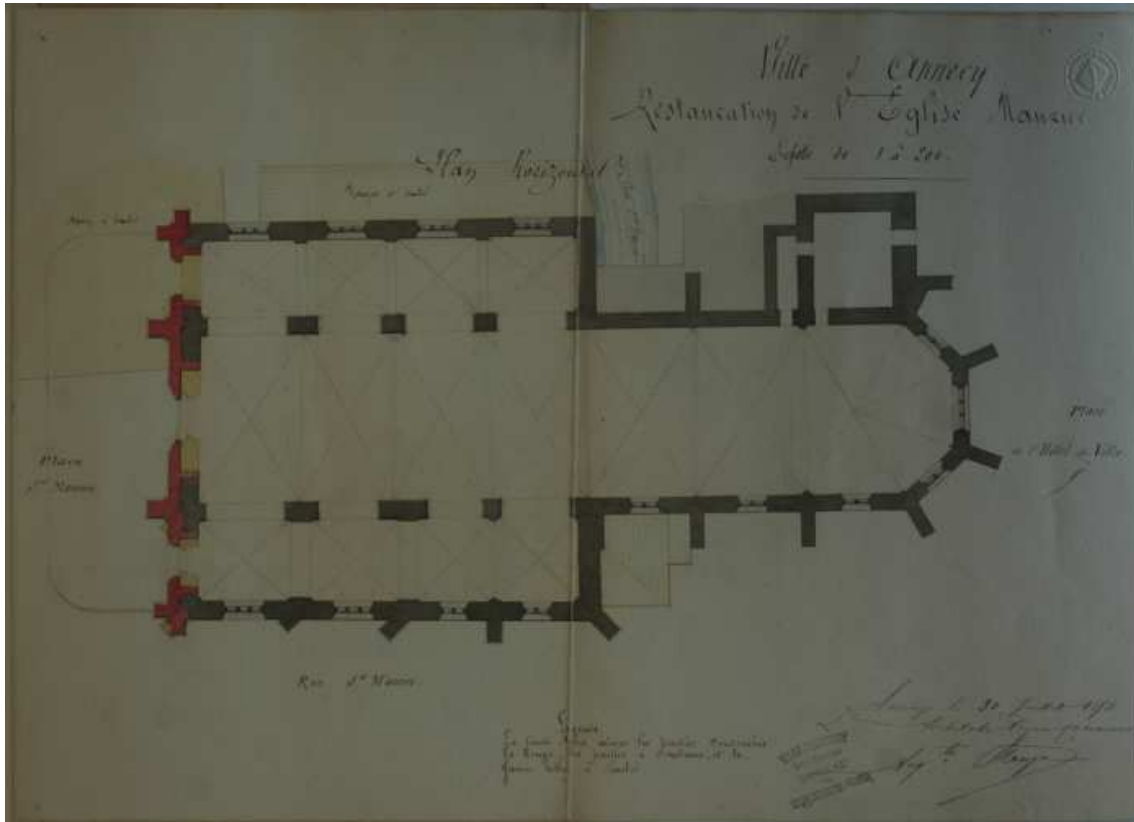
Restauration de l'église St Maurice : plan horizontal ; Auguste MANGE, 1874 (A.M.A. : 2 Mo 3/043*)
